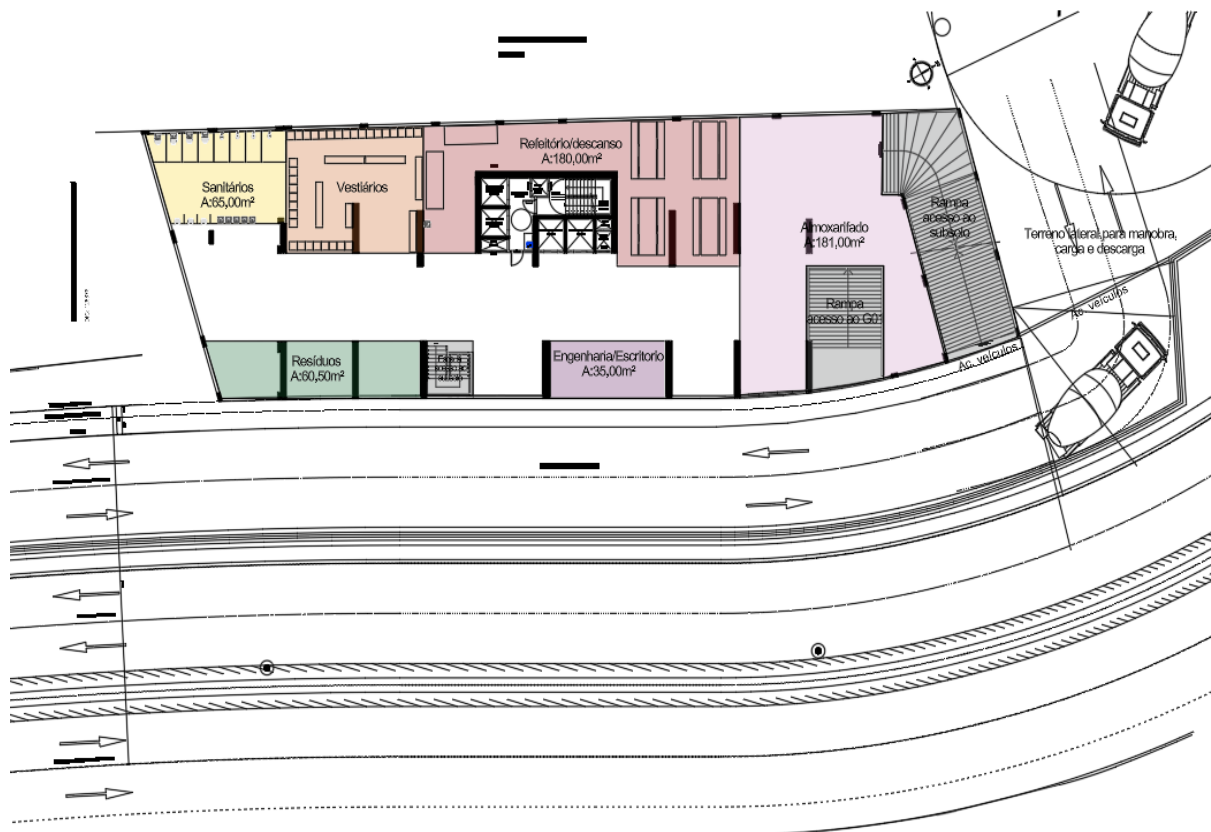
Planta do canteiro de obras – pavimento térreo.
